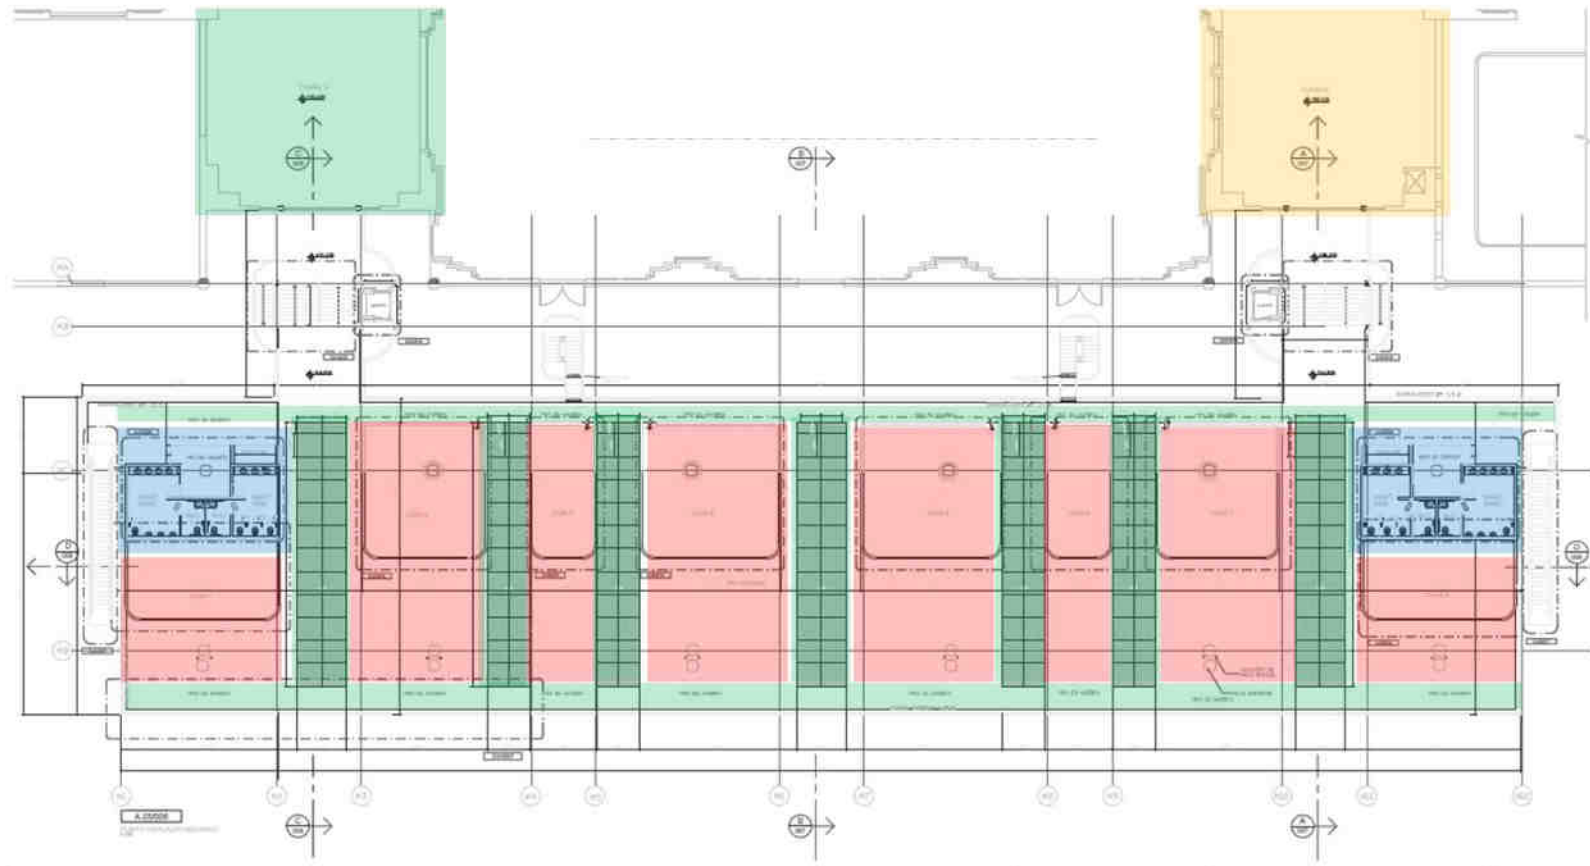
Planta Térreo - Mercado Municipal Paulistano
